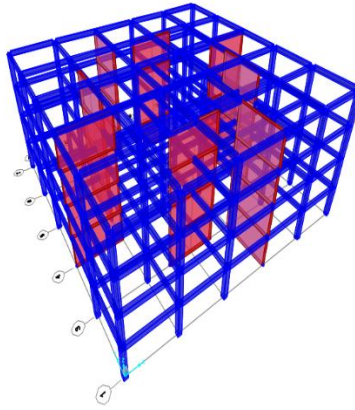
2. Tip yapının üç boyutlu modelli
